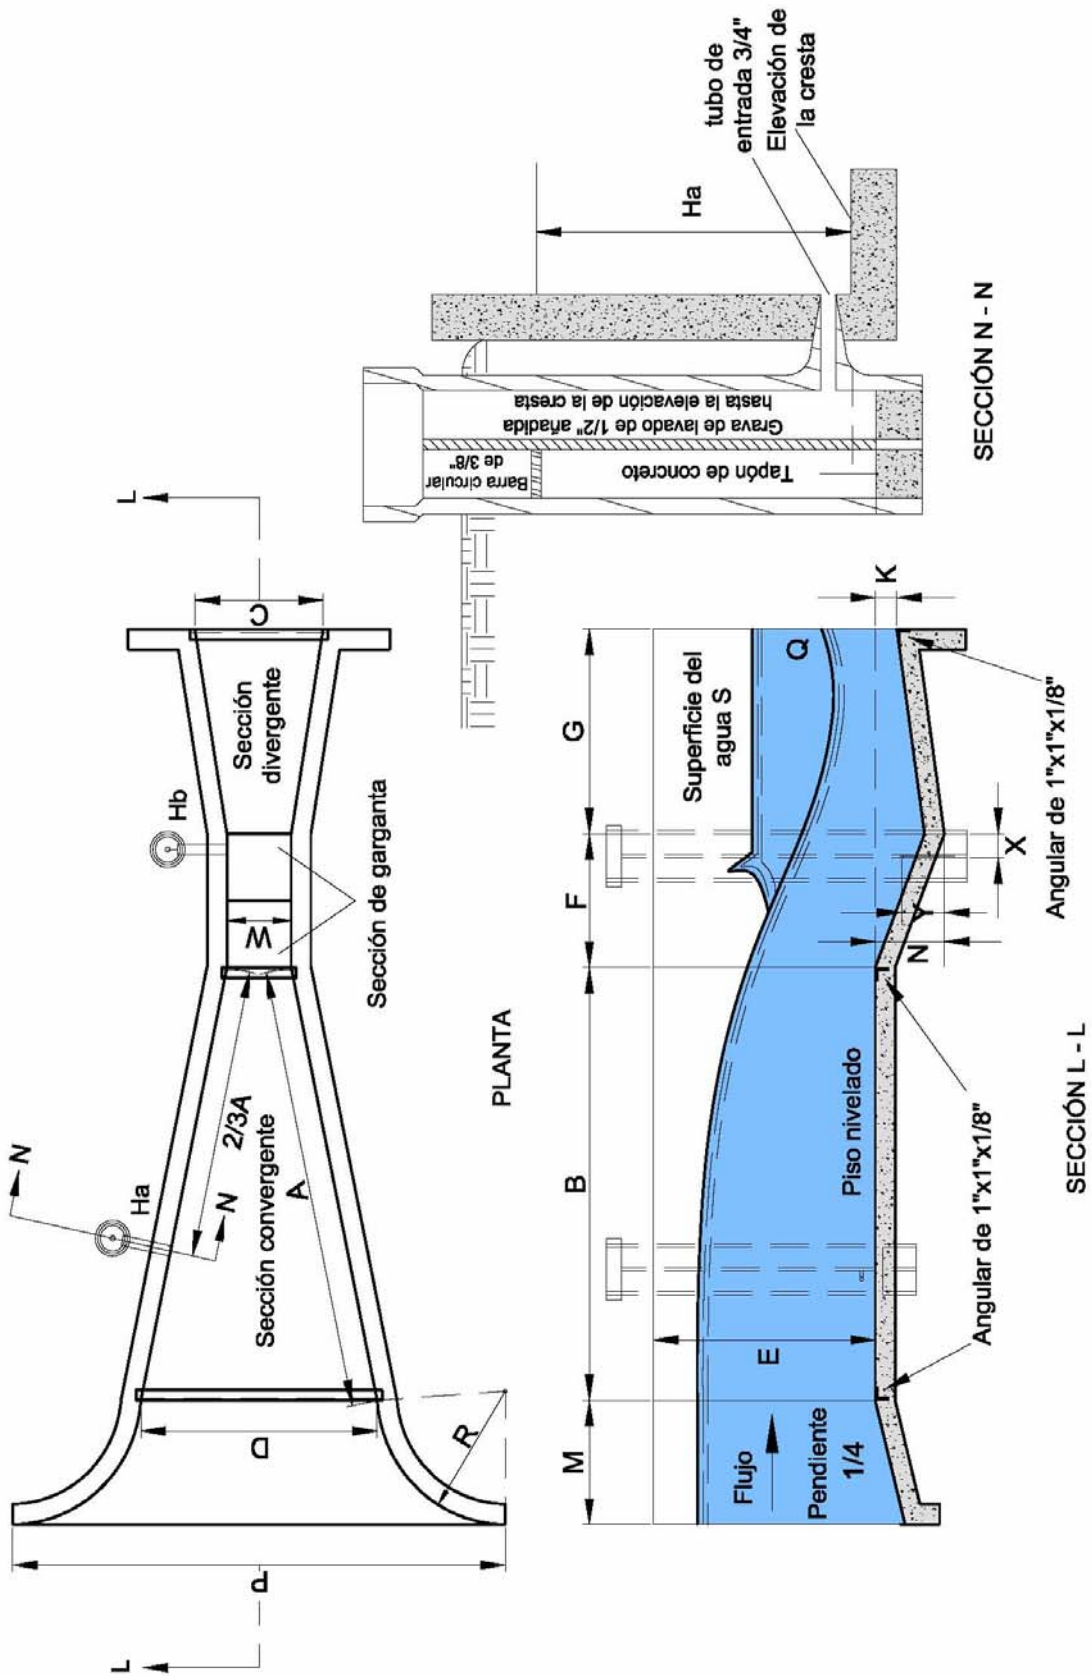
Planta, elevación y dimensiones de una canaleta Parshall
